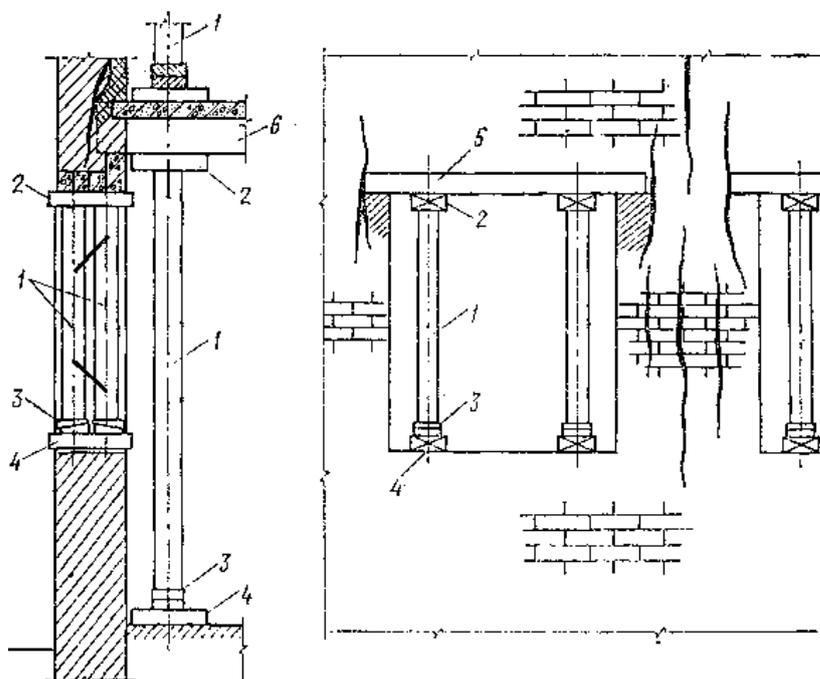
Укрепление и разгрузка от массы перекрытий поврежденных простенков стойками
